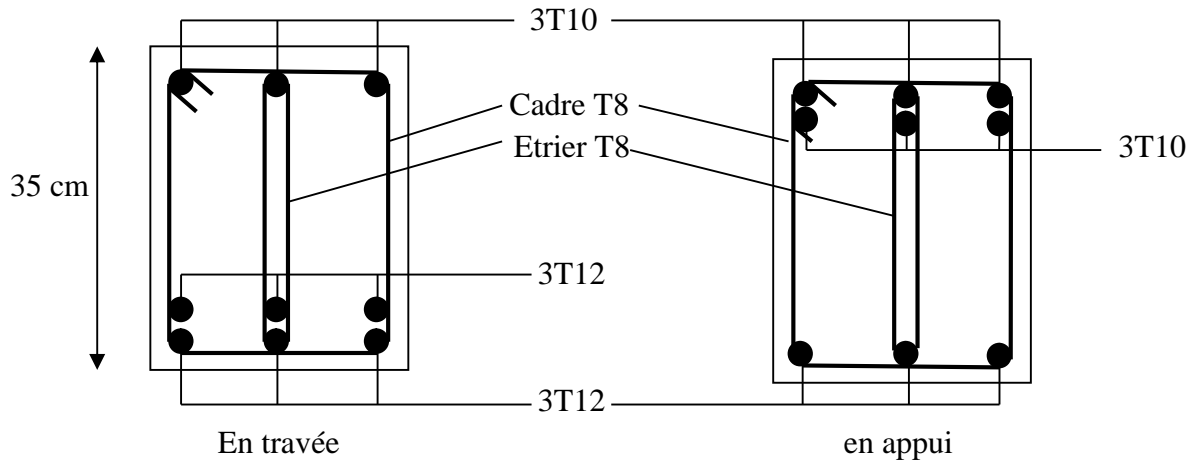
Schéma de ferrailage de la poutre brisée.
